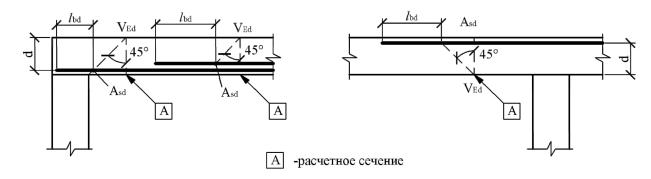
Положение расчётного сечения при определении площади поперечного армирования в формуле (7.12)
